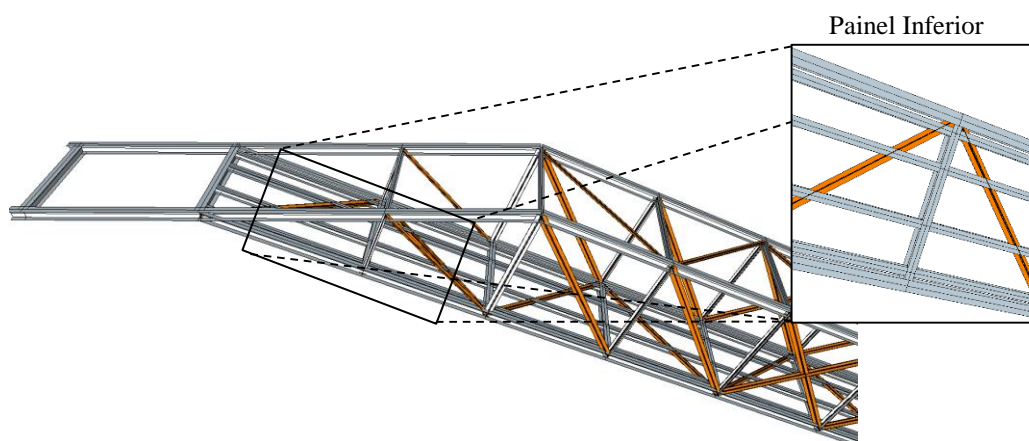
Pormenor do Painel Inferior da Treliça espacial da Ponte
